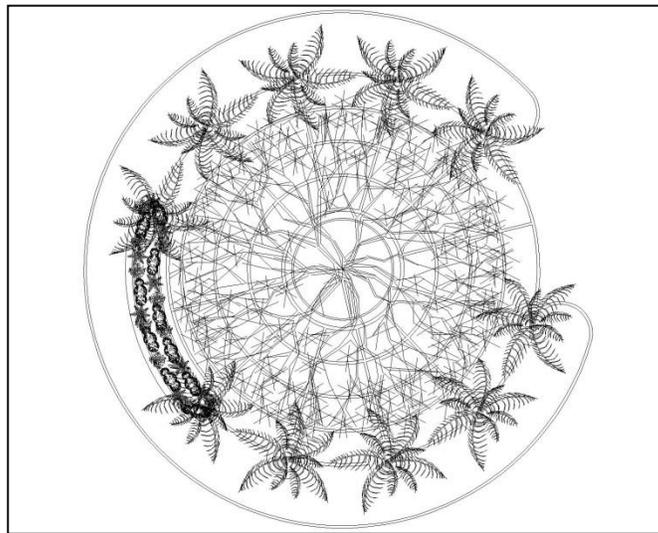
28. Planta Arquitectónica Alta tipo de la Caseta de Ingreso.
